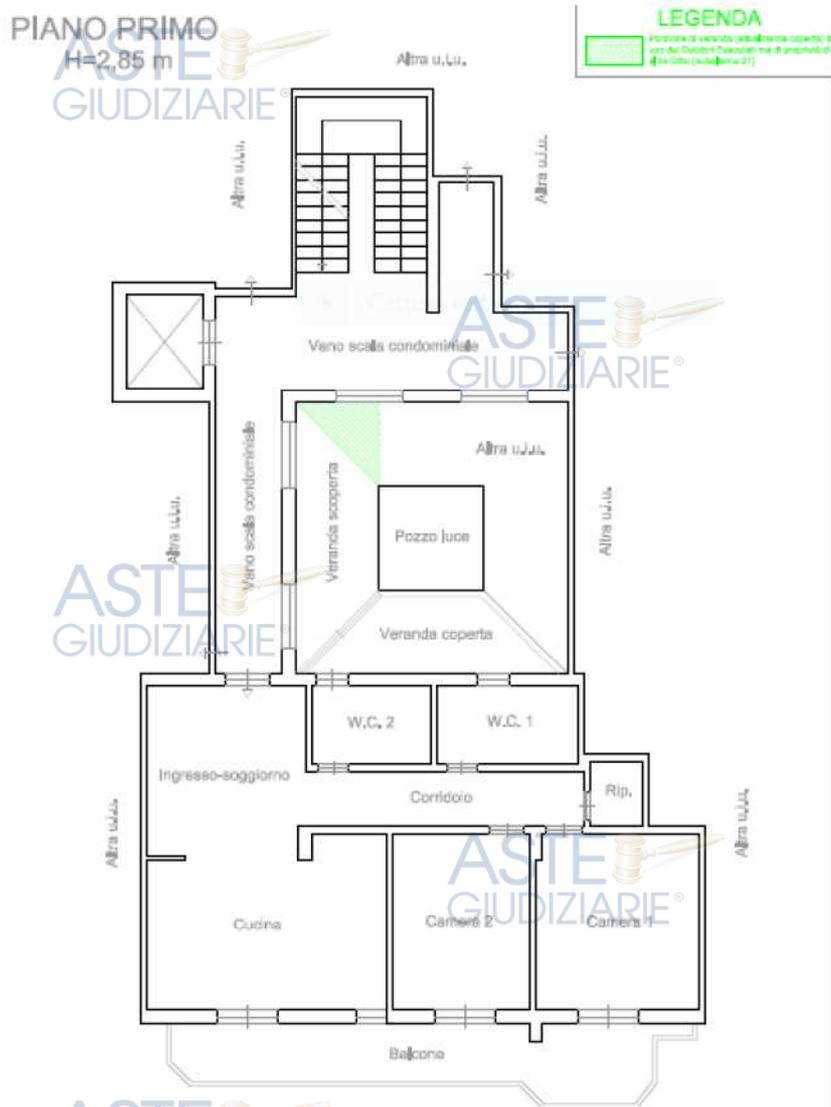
Planimetria - Stato di fatto rilevato dal C.T.U.
